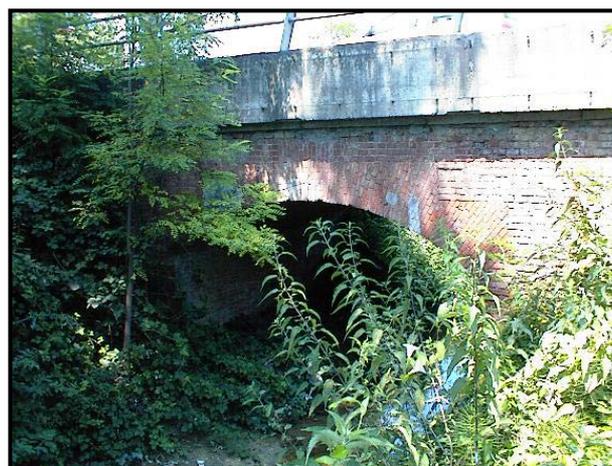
Vista verso valle dell'attraversamento stradale in muratura sul T. Gattola.
